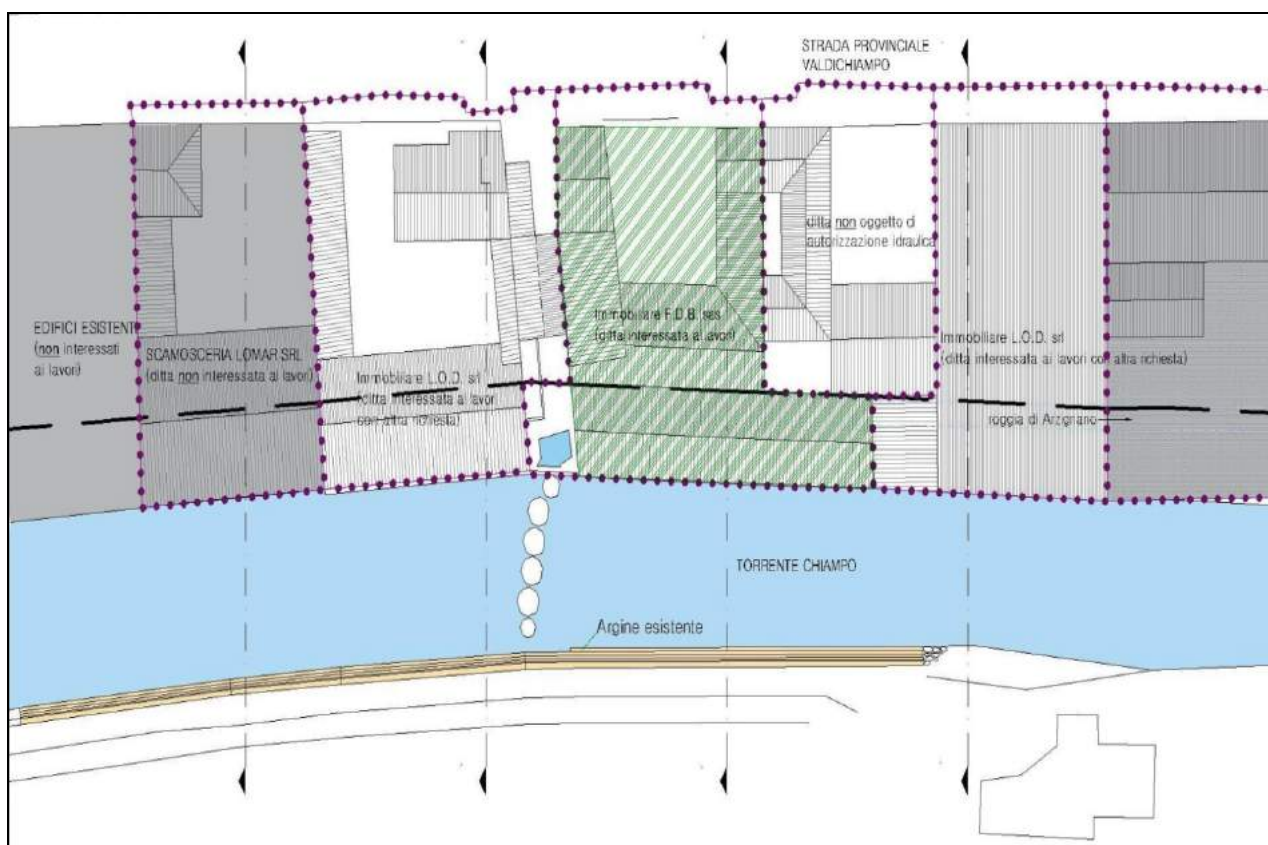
Pianta dell'area, in verde il lotto F.D.B. Sas (estratto dalla relazione tecnica del progetto)
